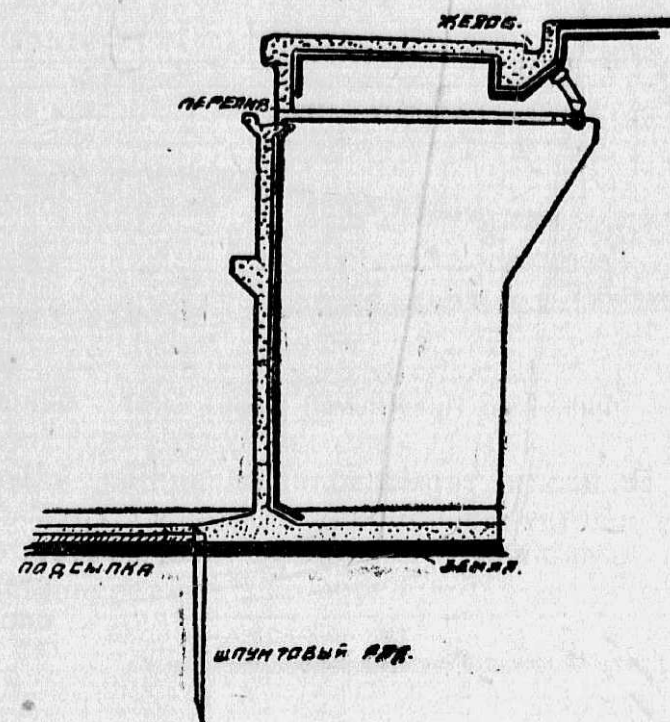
Разрез стенки плавательного бассейна в Геттингене.
